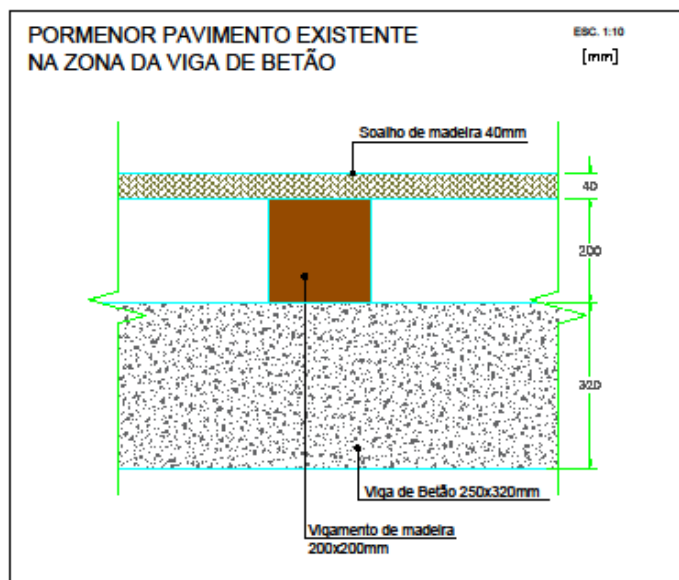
Pormenor do pavimento existente na zona da viga de betão (antes)
